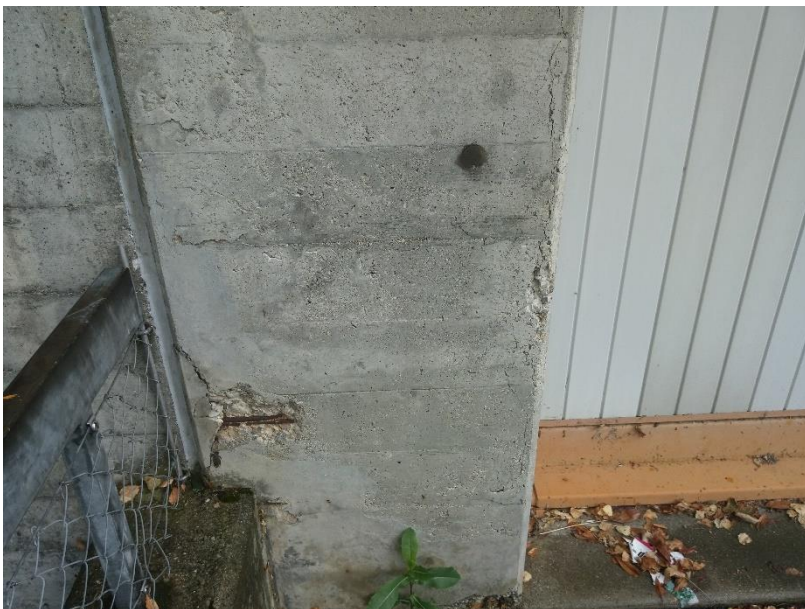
armature corrodée et éclat de béton (axes 1' – A')
